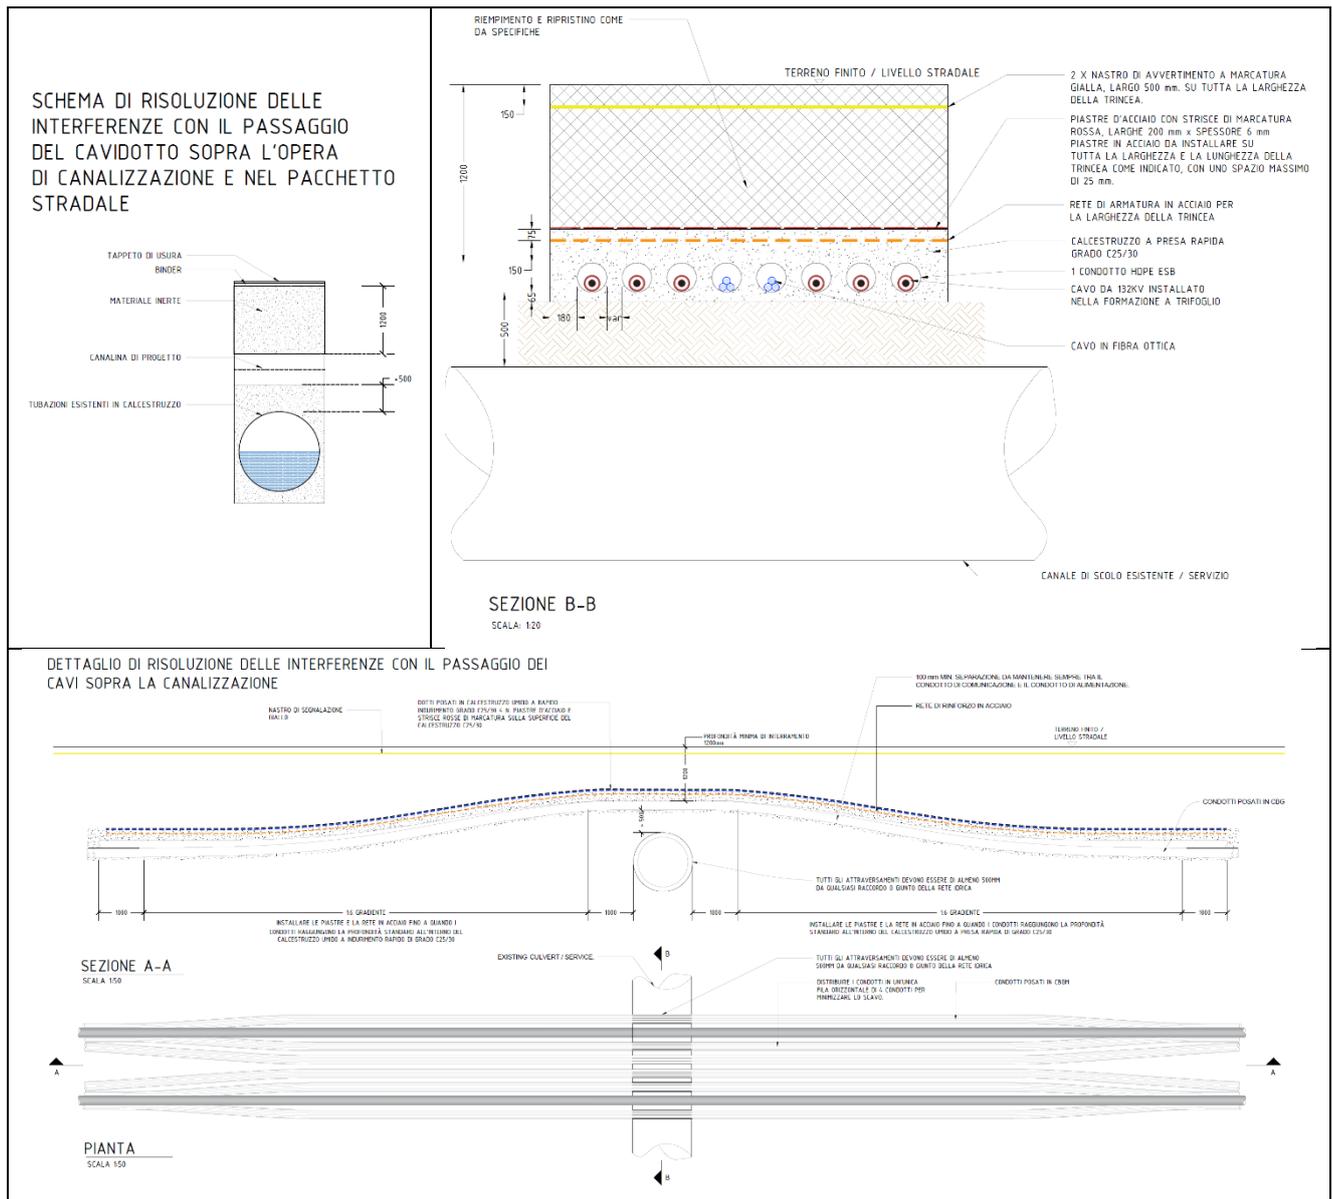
Scavo su strada con passaggio del cavidotto sopra l'opera di canalizzazione esistente (disegno fuori scala, misure in millimetri)³.
